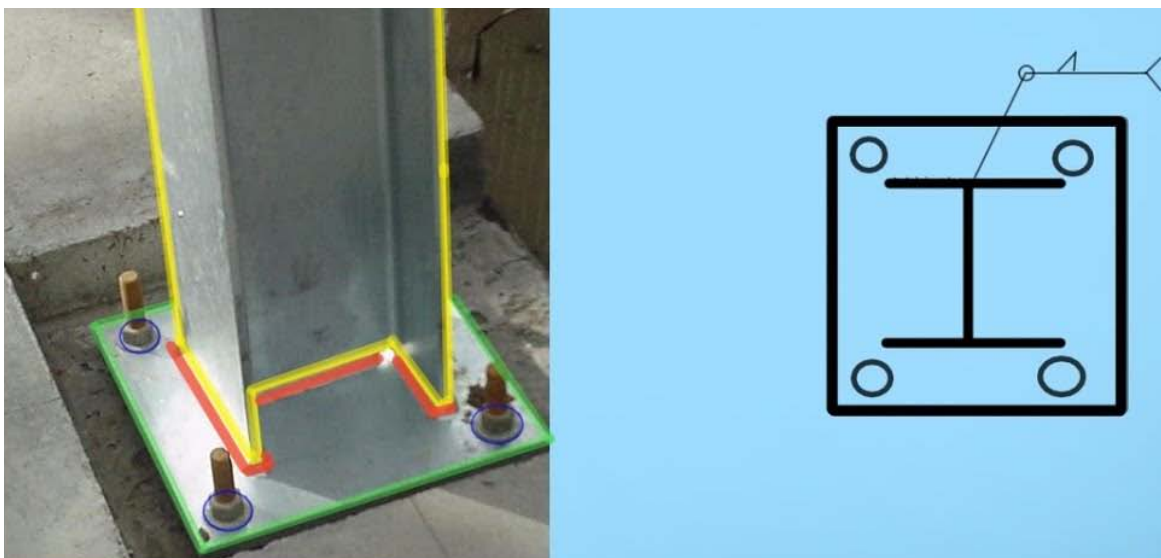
Ilustración y vista en corte de una placa base unida a una columna de acero.
